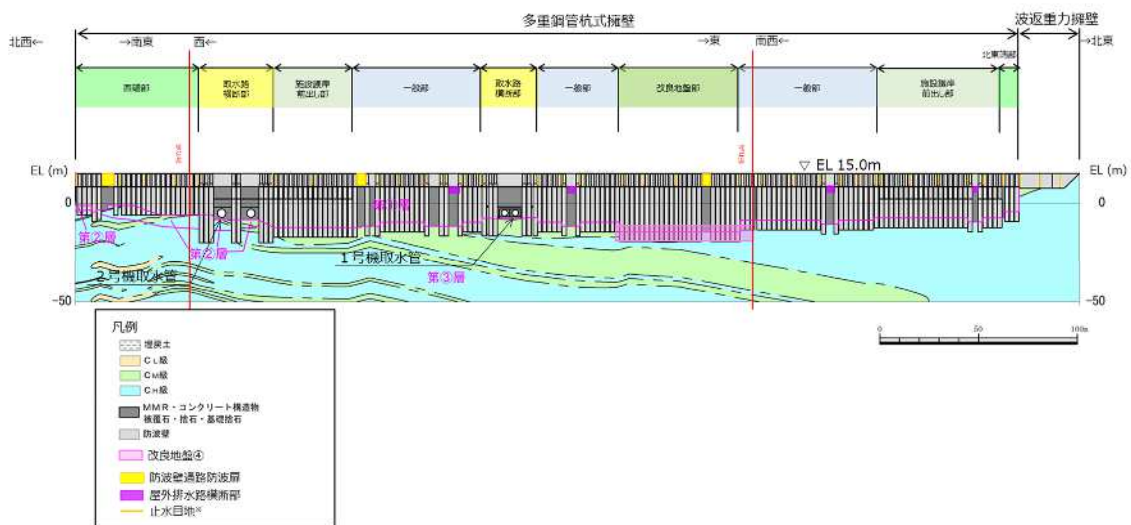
防波壁（多重鋼管杭式擁壁）の縦断面図
